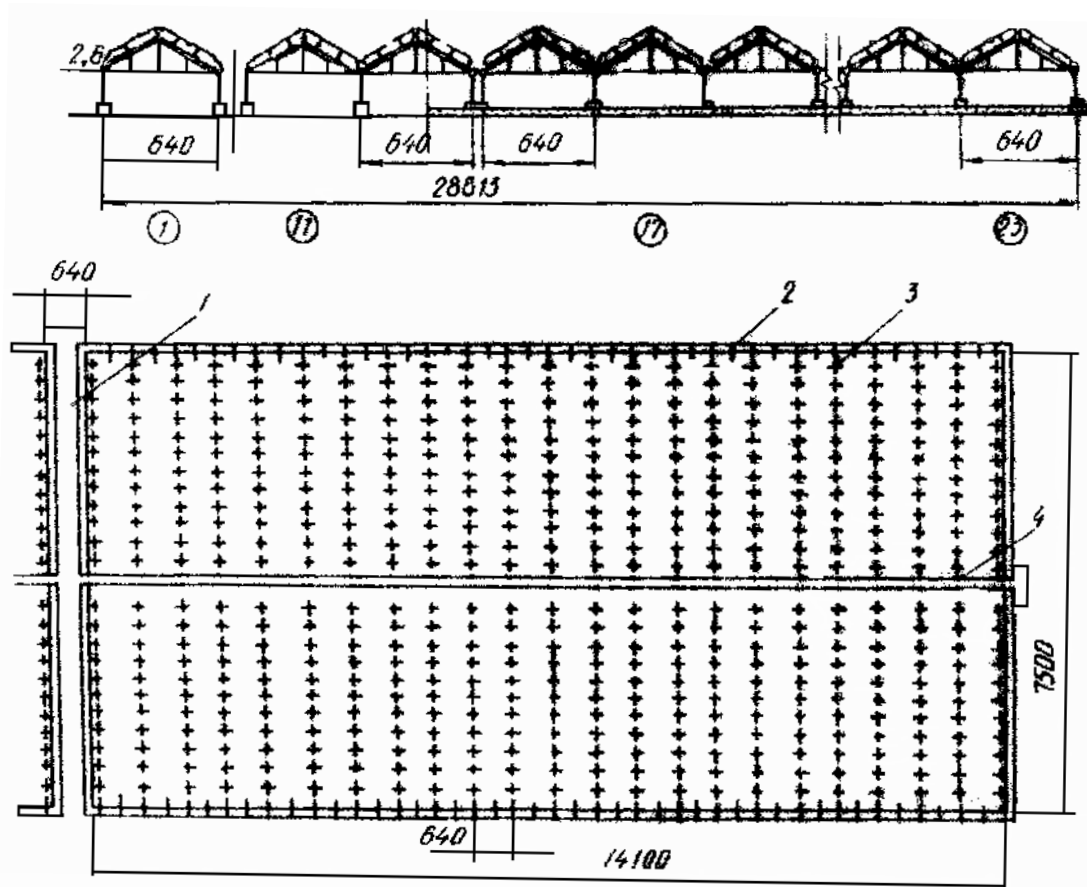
Торцевой фасад и план зимней блочной теплицы (мм):
